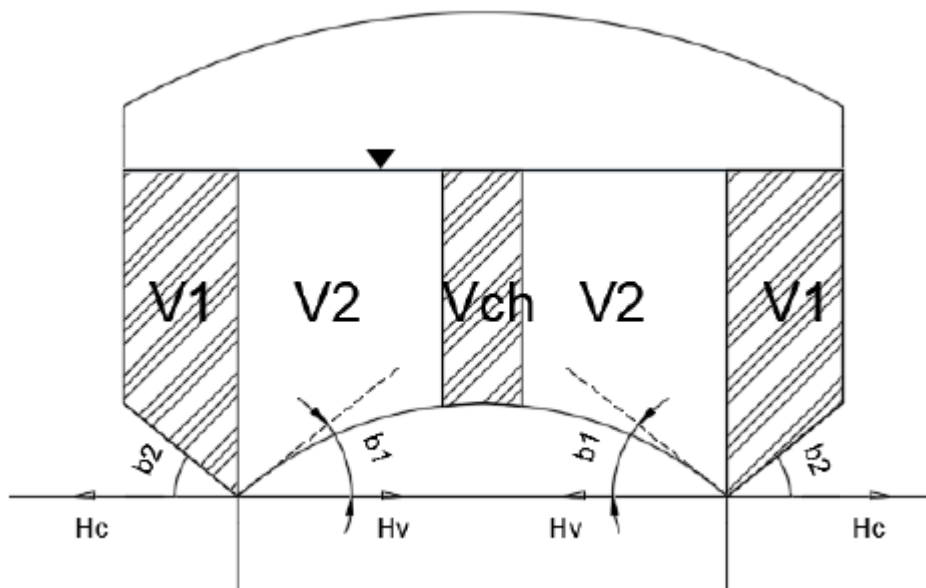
Equilibrio de fuerzas sobre la viga de fondo.
